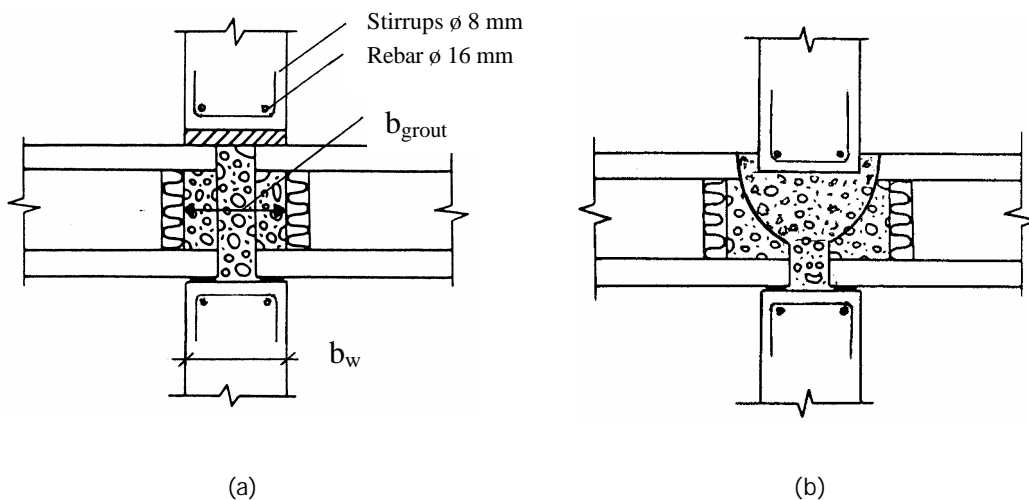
Exemplos de ligações entre painel e laje alveolar
